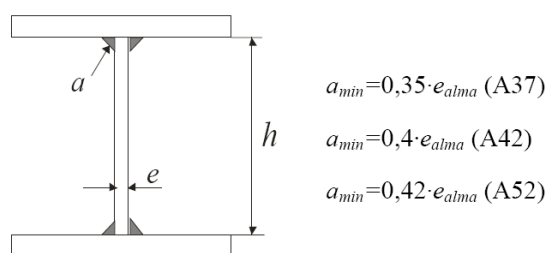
GARGANTAS MÍNIMAS EN VIGAS ARMADAS
